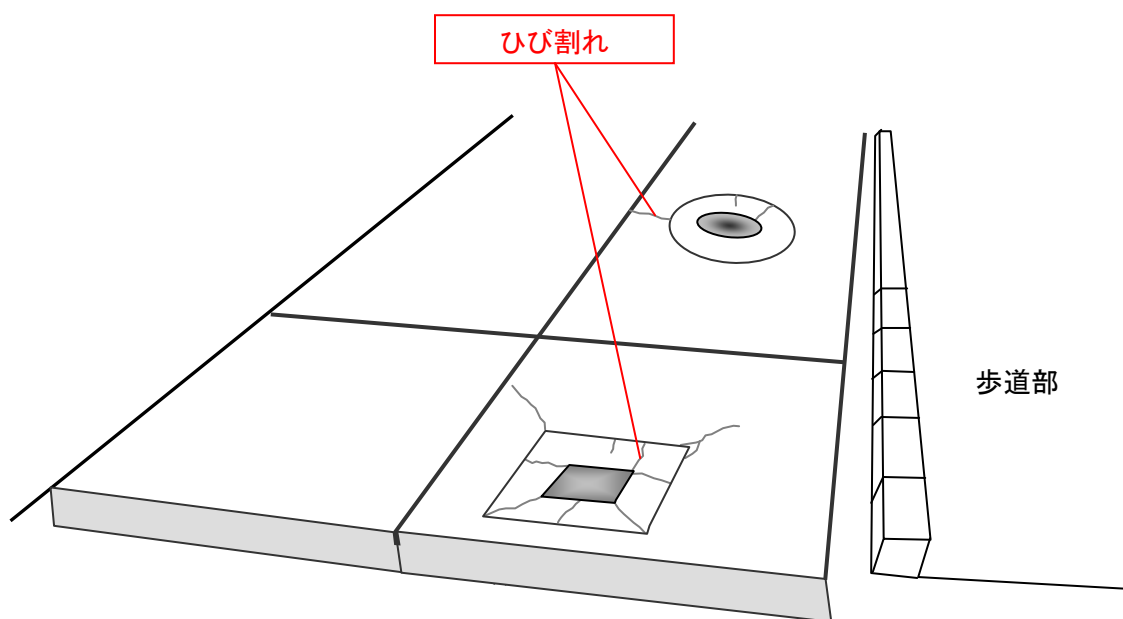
隣接構造物境界とのひび割れのイメージ
